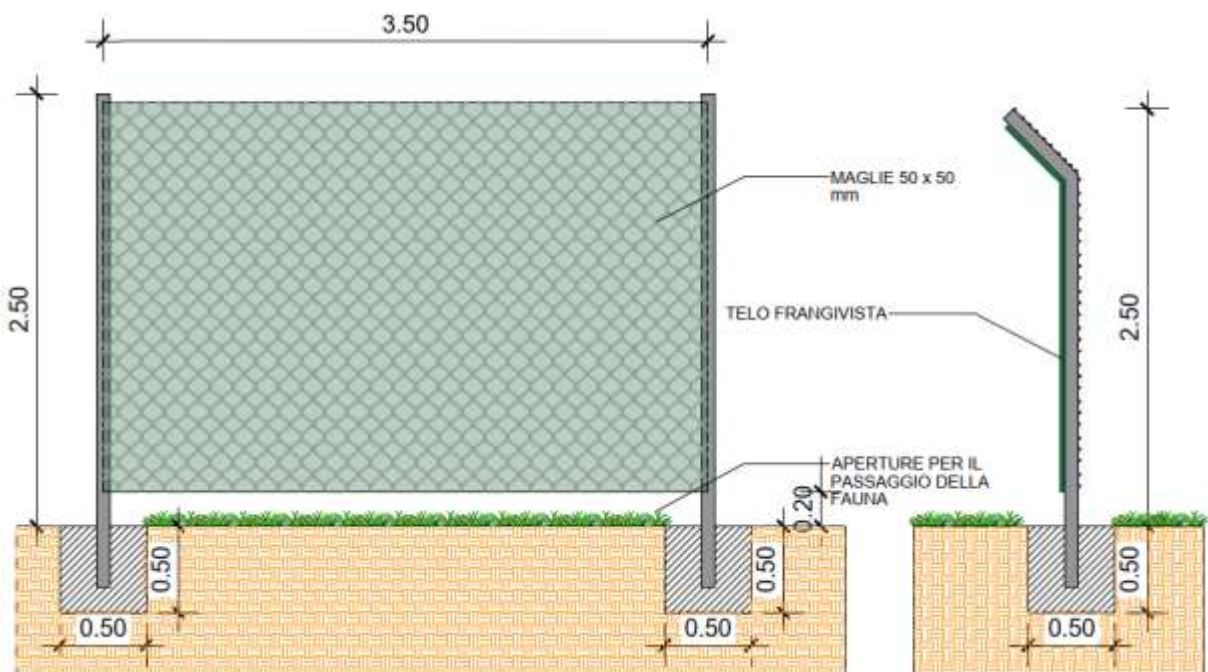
Estratto elaborato FAB.ENG.TAV.048.00_Planimetria, sezioni e dettaglio degli interventi di mitigazione abbagliamento – particolare telo frangivista
